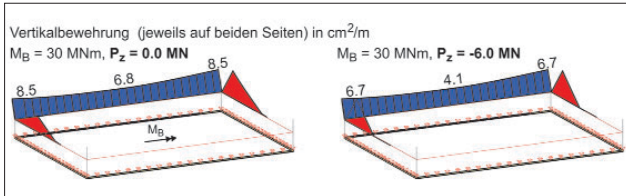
Vertikalbewehrung nach der Schalenberechnung im Einspannbereich für 2 Lastfälle
